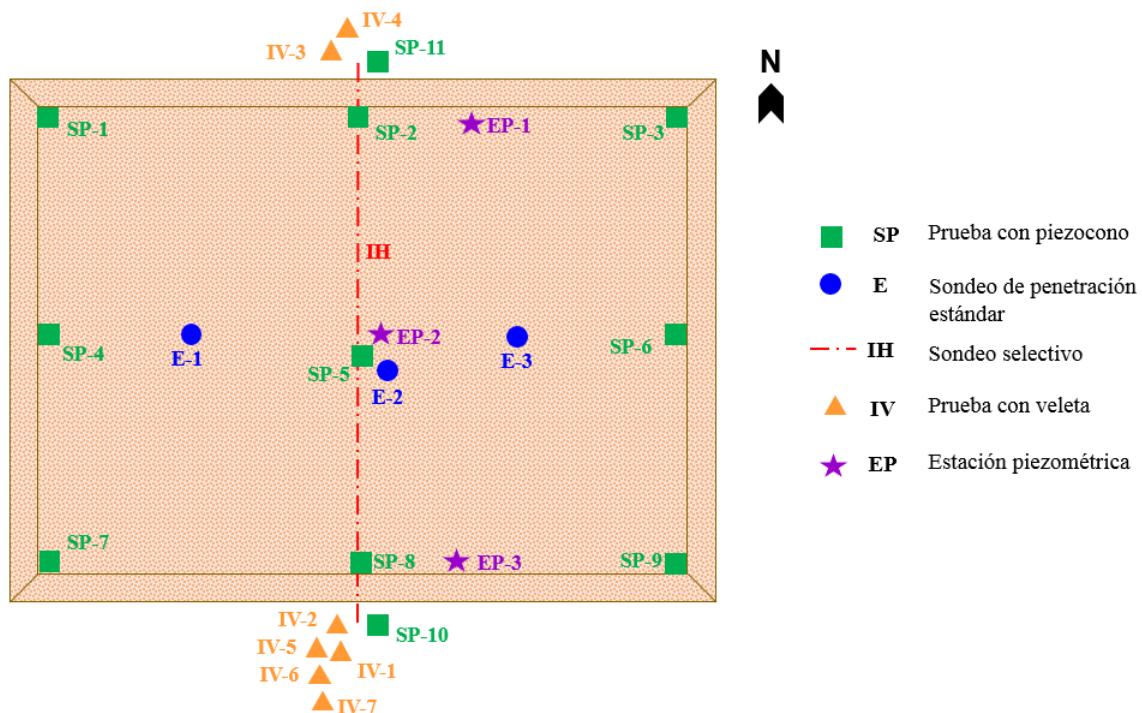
Instrumentación en el tramo de prueba con vacío dren a dren.
